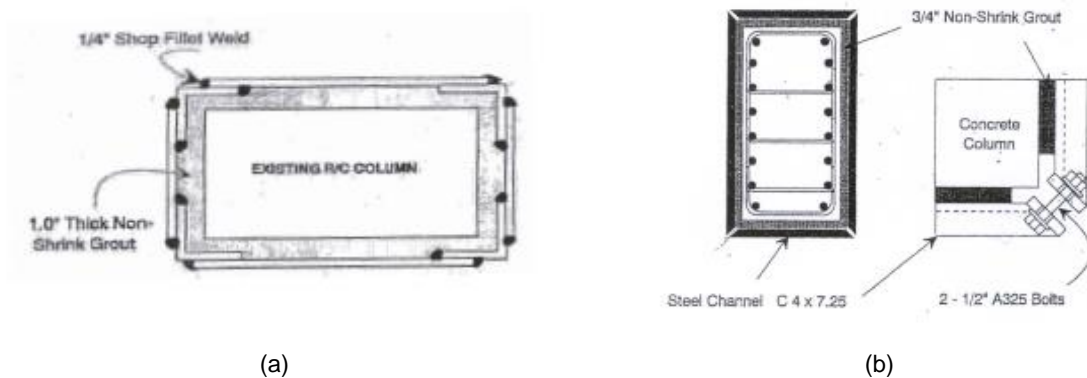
Encamisamento de pilares com chapas metálicas – adaptado de Sousa (2008)
